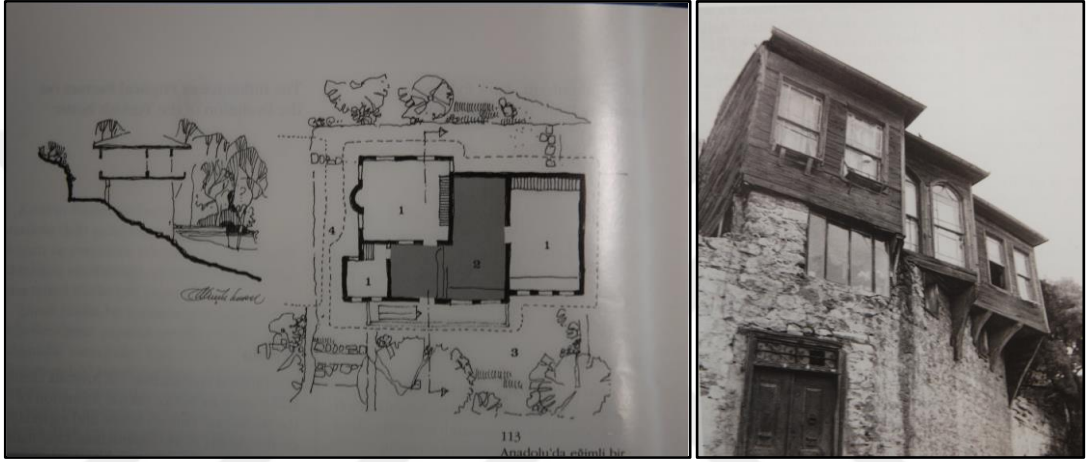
Orta sofalı plan tipi (Küçükerman, 1973)
